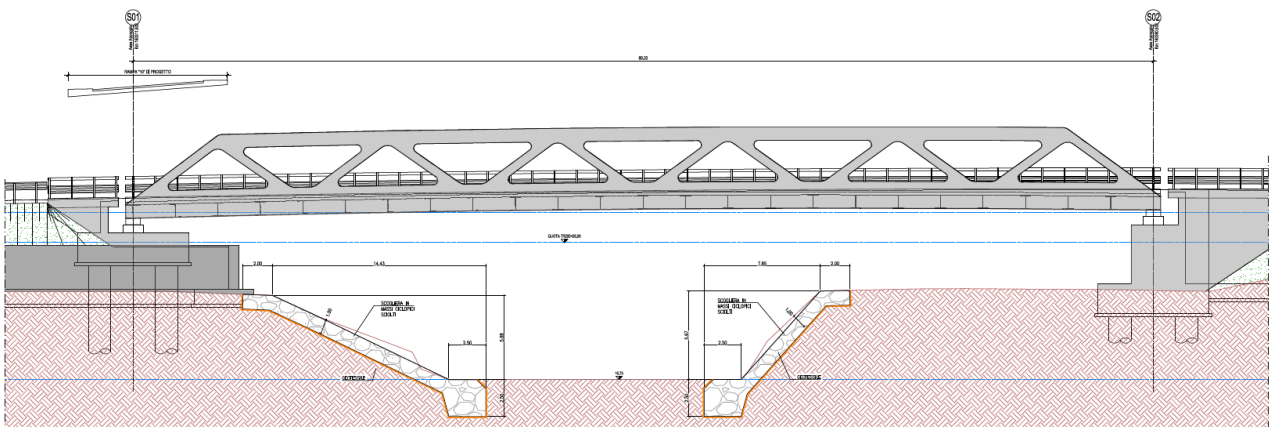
Prospetto del ponte di progetto della complanare lato valle
